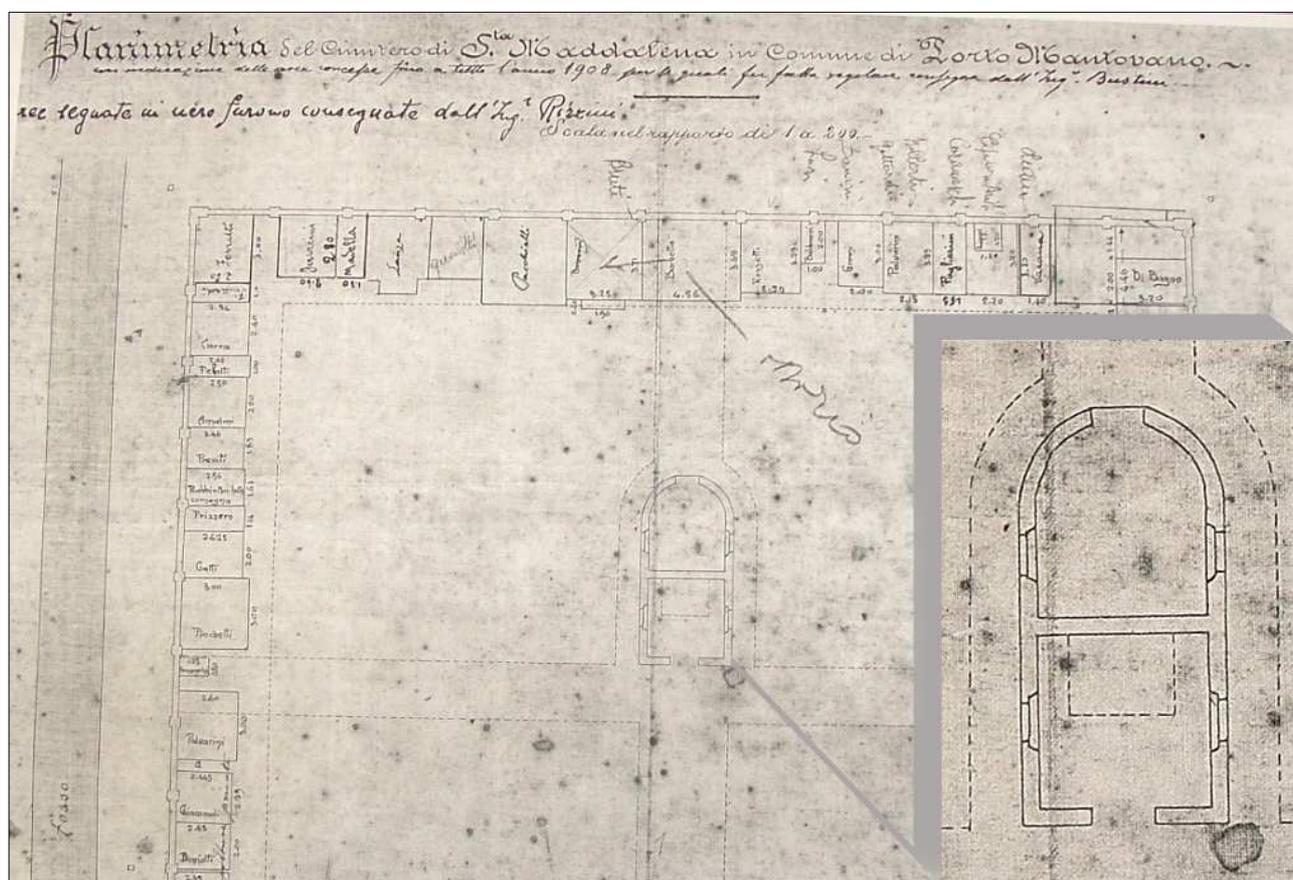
Estratto planimetria generale del cimitero di S. Maddalena – anno 1908
